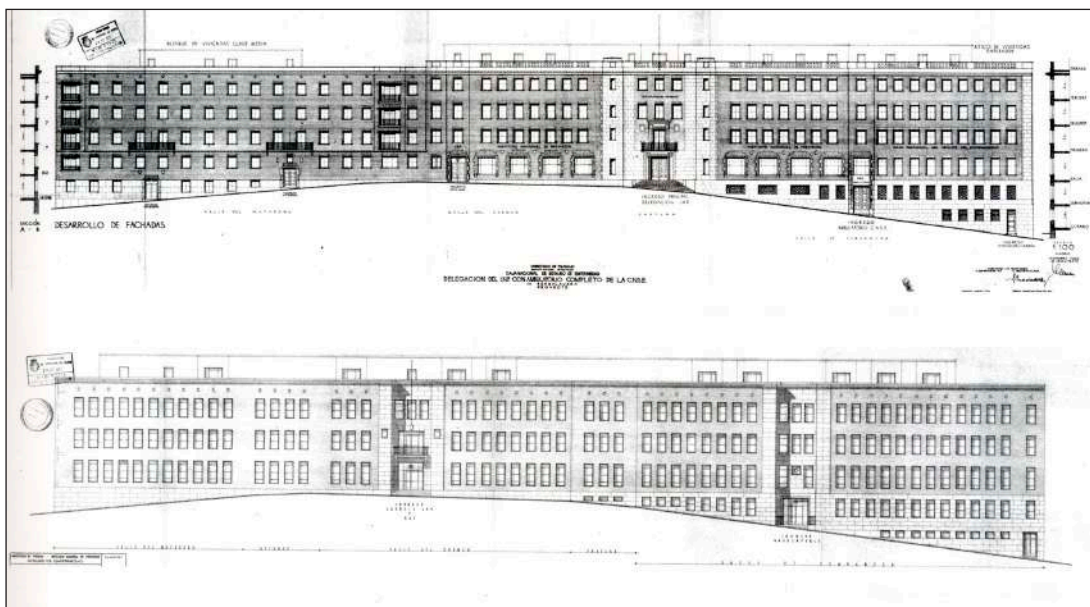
Proyectos Sede del Instituto Nacional de Previsión en Guadalajara. Alzados desarrollados de fachadas.* Arquitecto: Fernando García Mercadal, 1949 y 1953. Archivo Municipal de Guadalajara.
